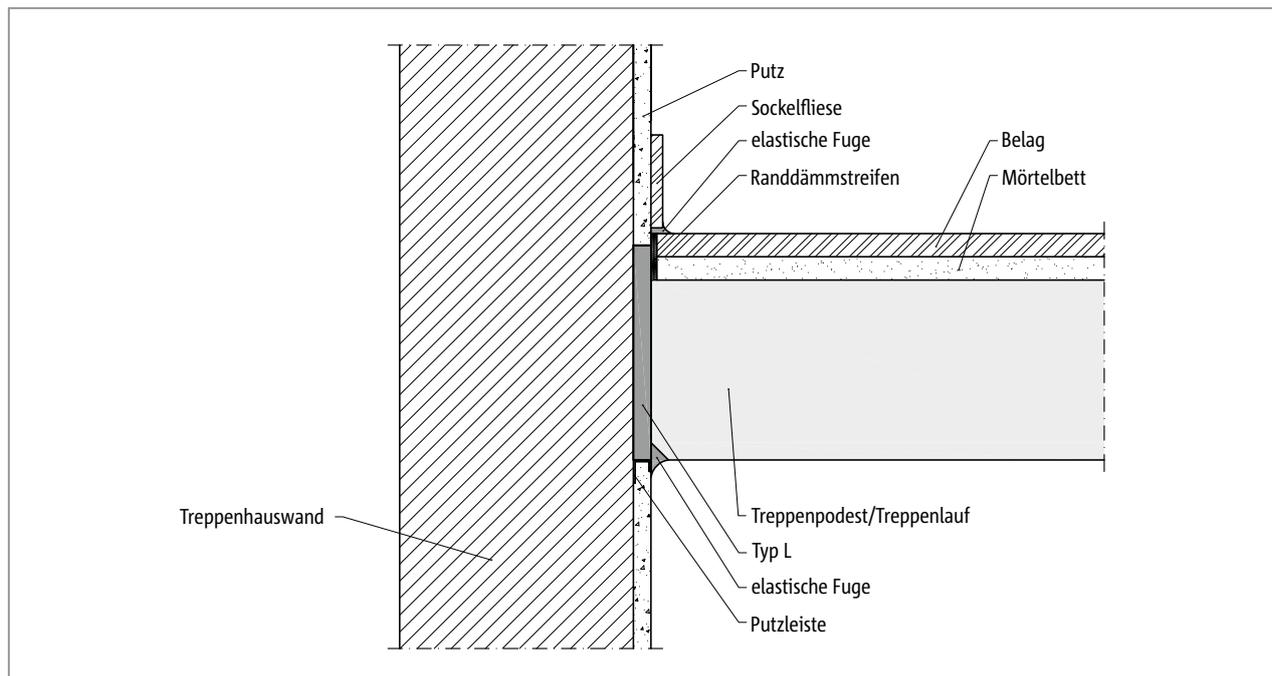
Schöck Tronsole® Typ L: Einbauschritt Fertigteiltreppe
